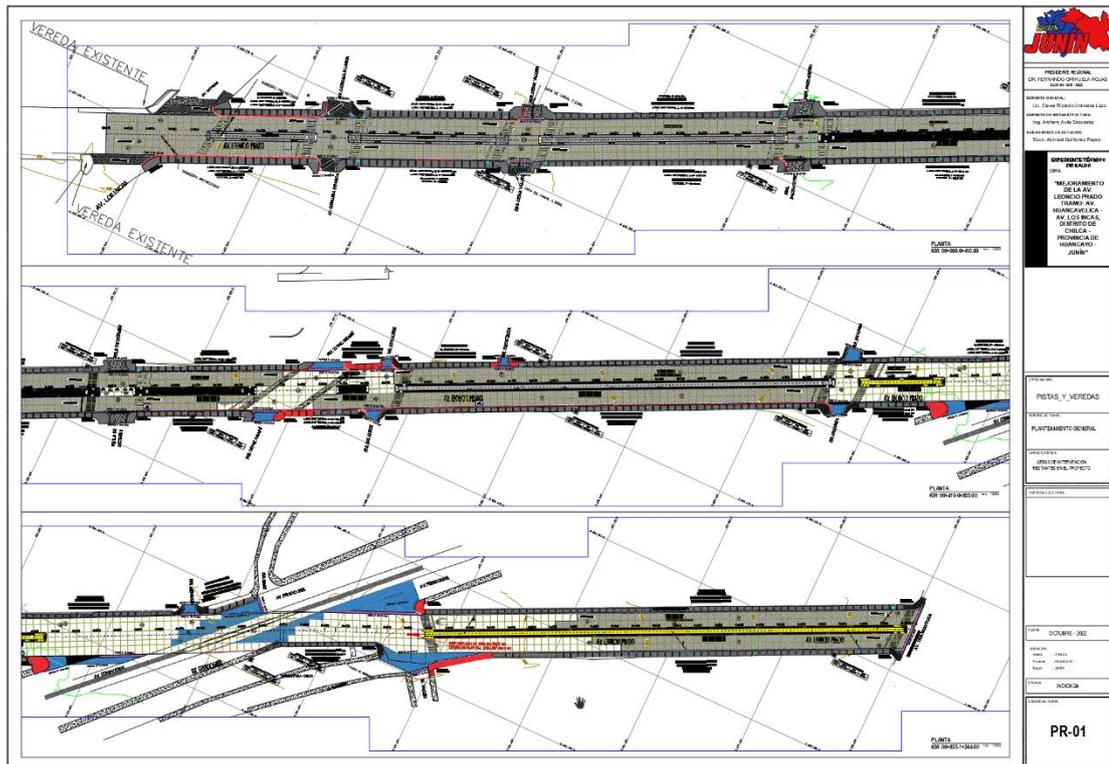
Plano clave del saldo de la obra con CUI N.º 2310610
